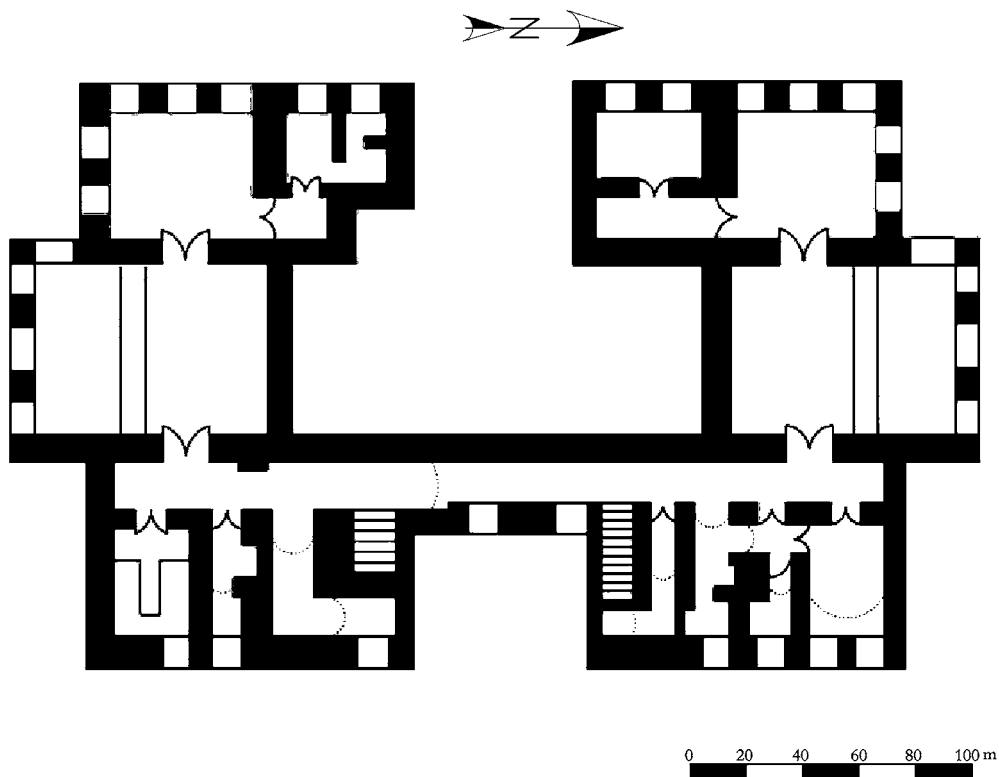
قصر علي باشا بن عون، الطابق الثاني، مسقط أفقي للحمام الملحق.
